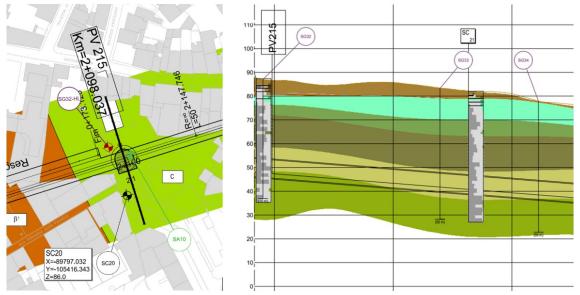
Planta e perfil longitudinal - Geologia / Geotecnia.
